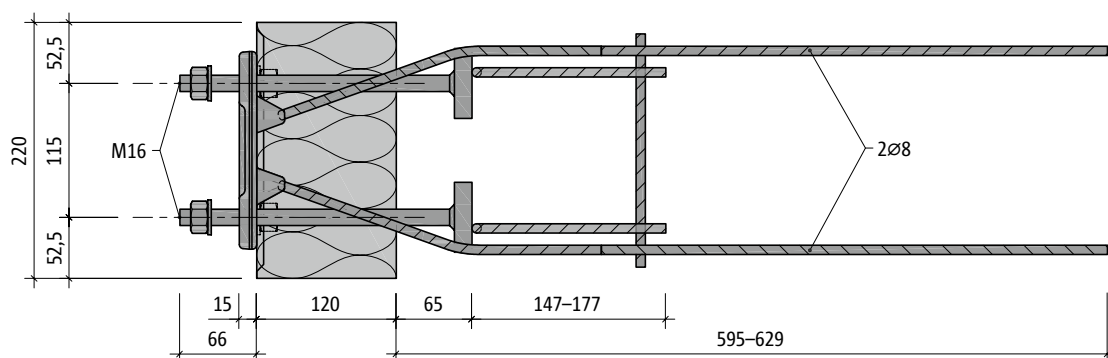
Schöck Isokorb® XT type SQ-V1 : vue en plan
